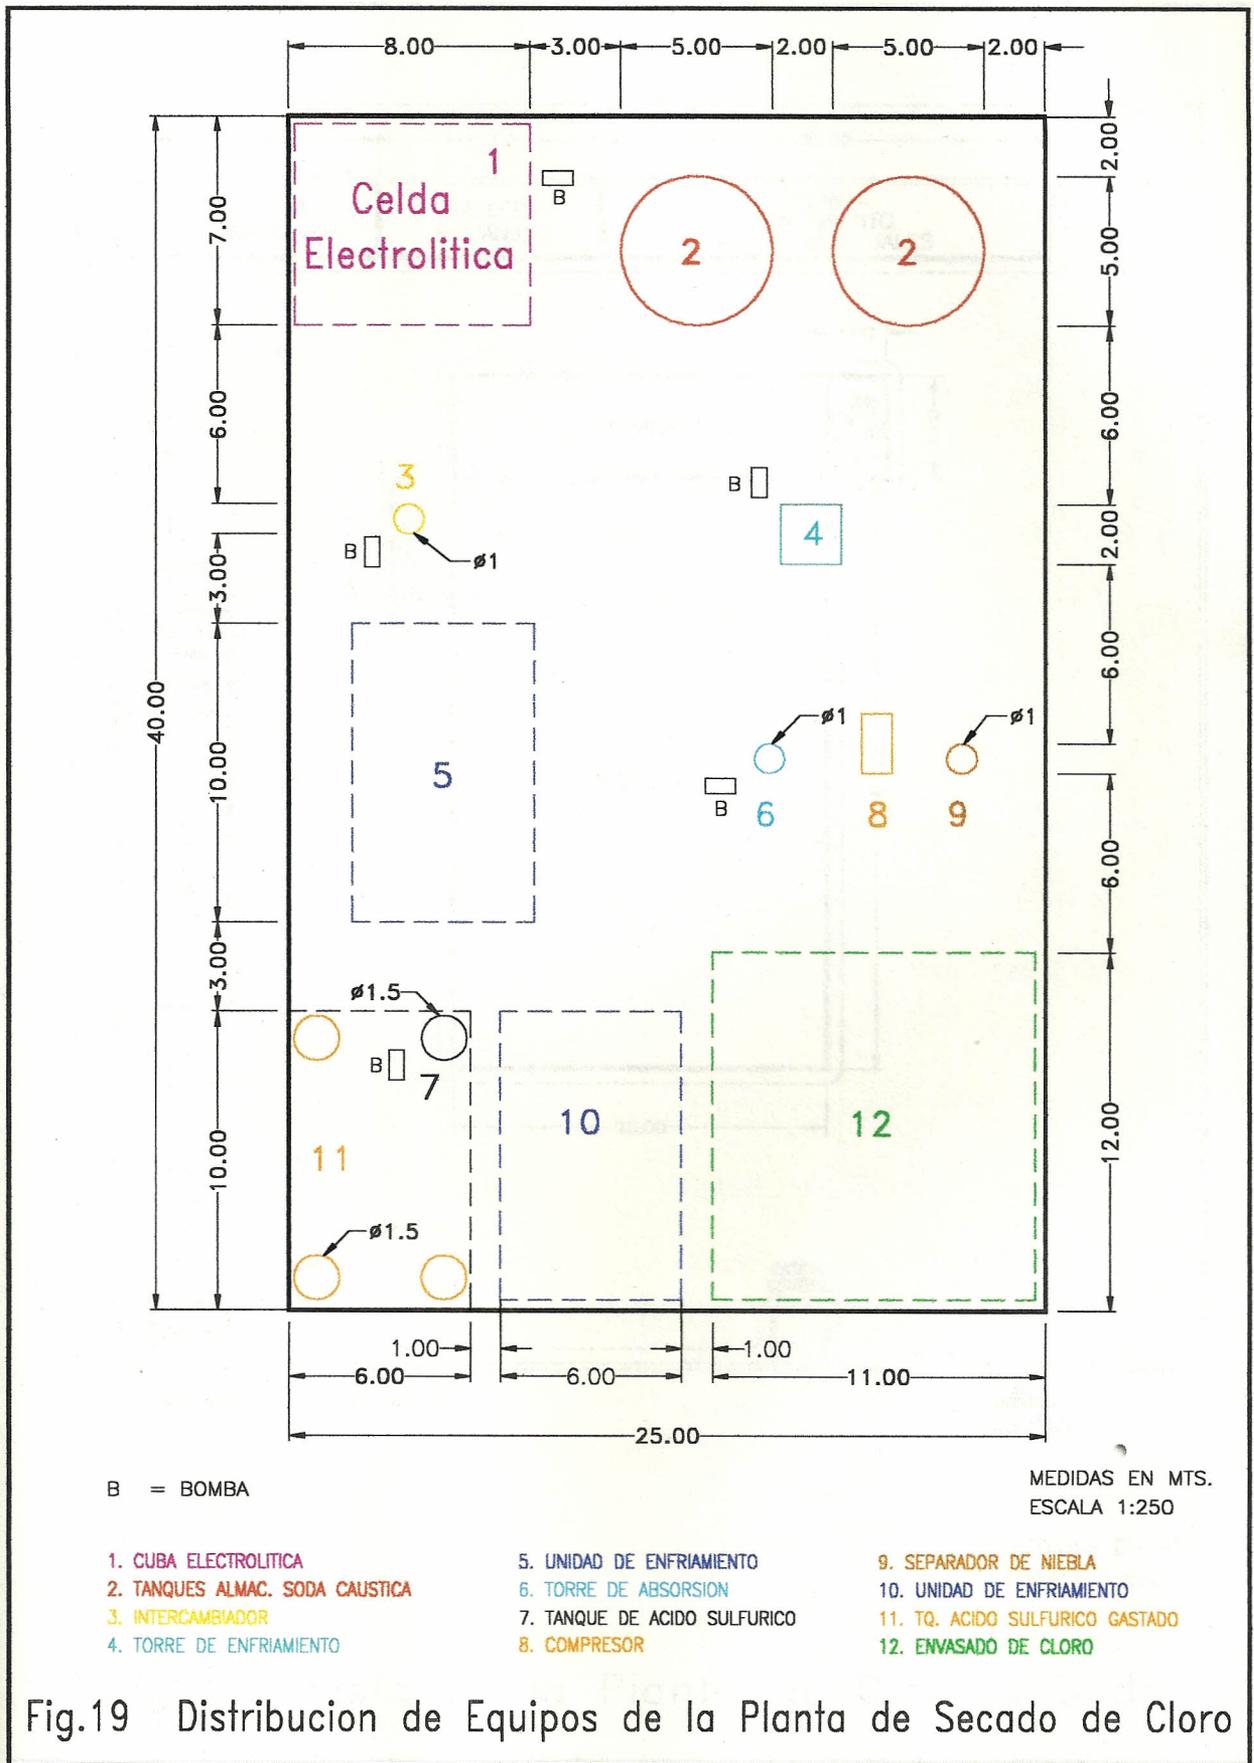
Distribucion de Equipos de la Planta de Secado de Cloro
